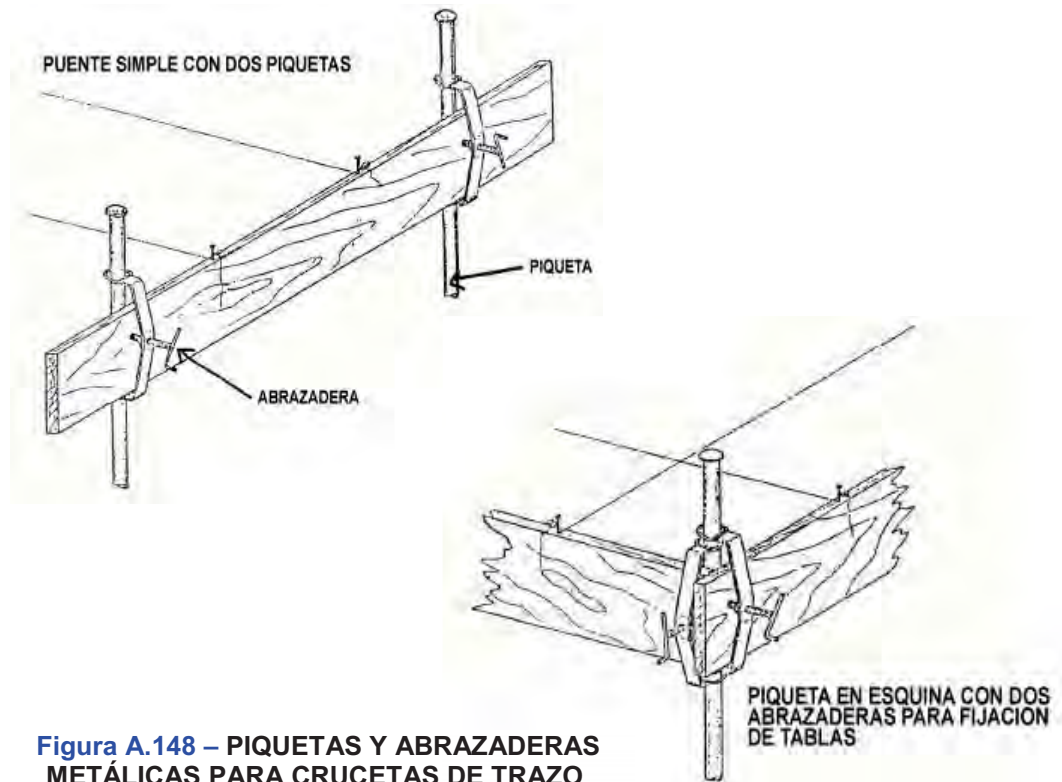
PIQUETAS Y ABRAZADERAS METÁLICAS PARA CRUCETAS DE TRAZO
